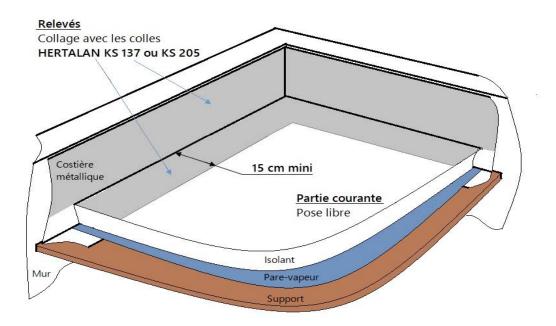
Zones de collage sur support (TAN ou bois) avec costière
